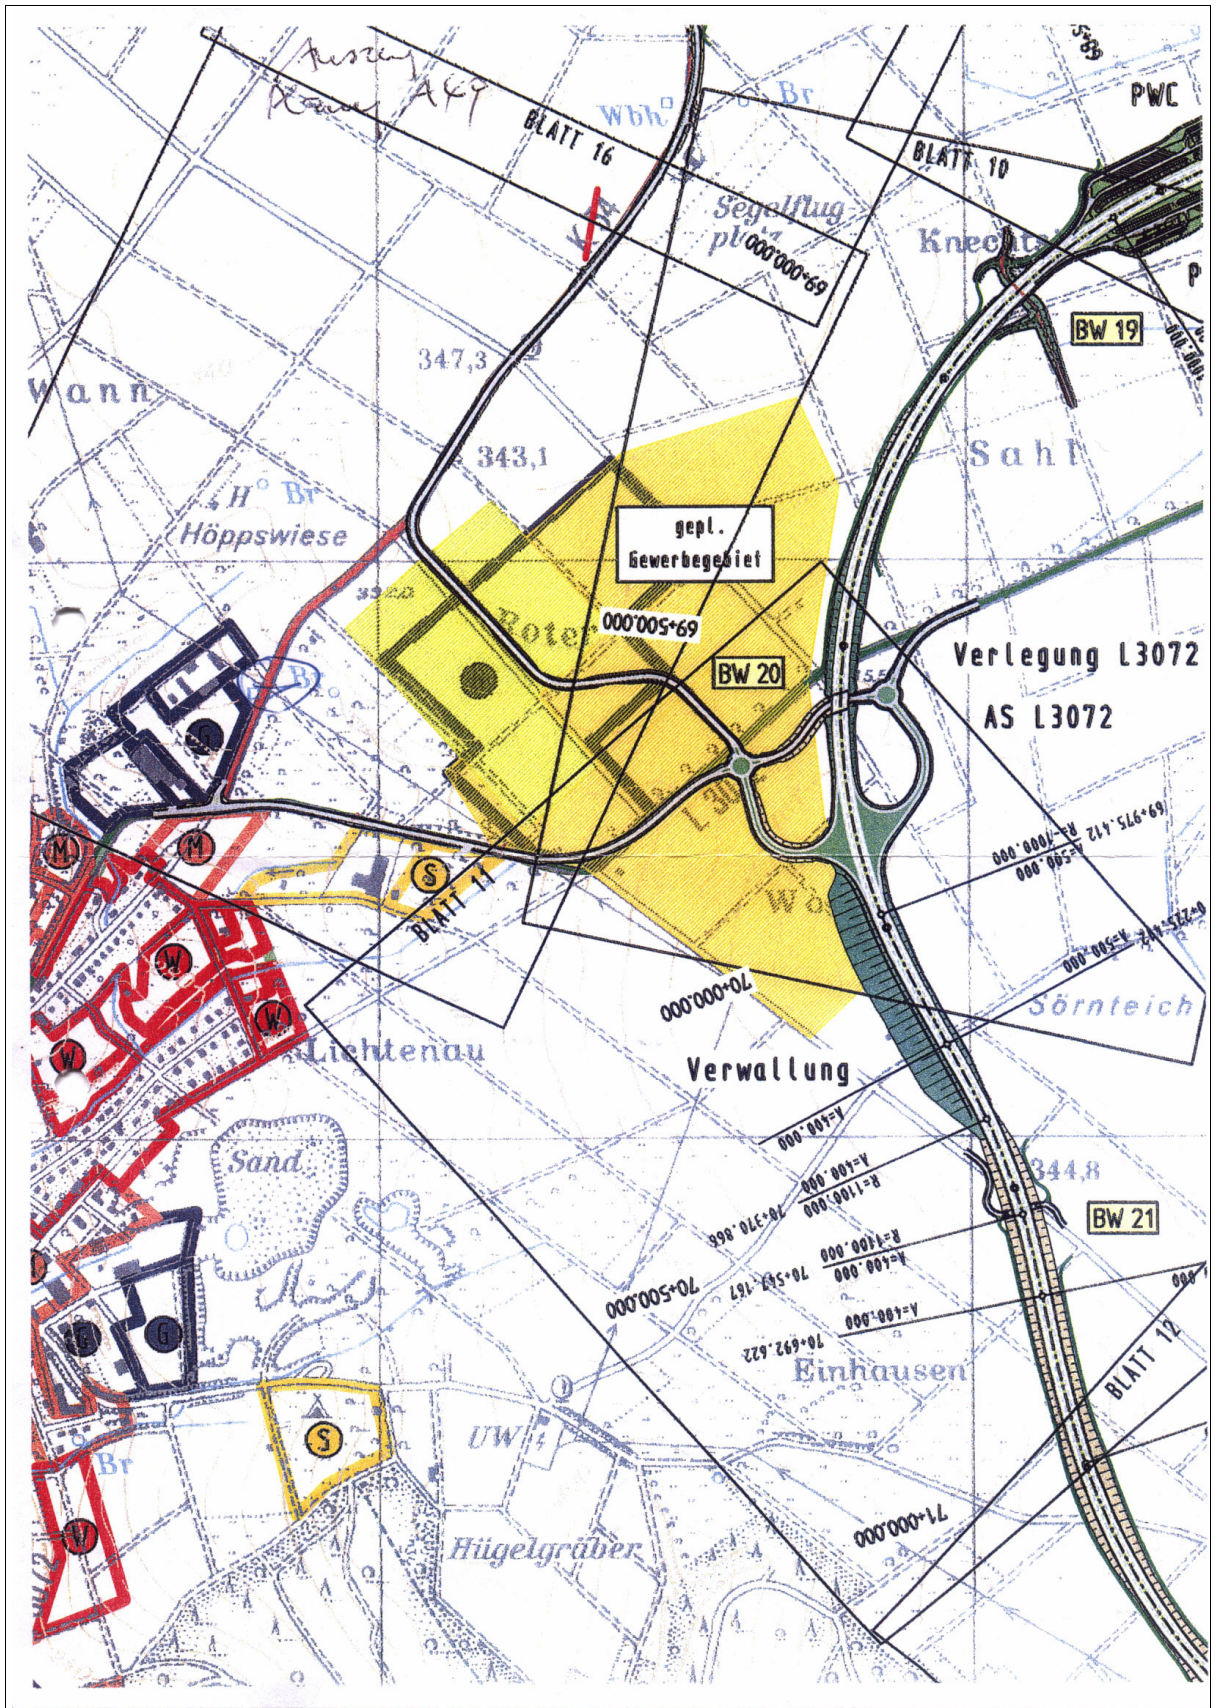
Lageplan der bestehenden Gebieteinstufungen.
